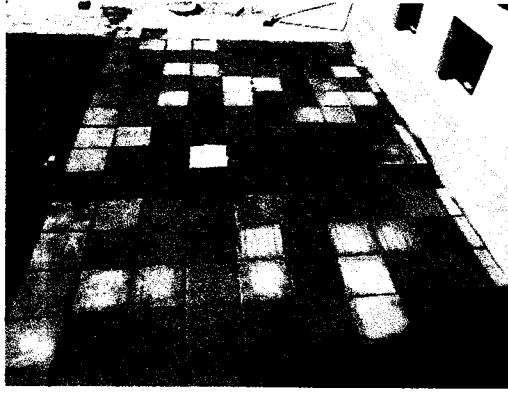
y 34: Colocación de ladrillo pastelero en techo de la zona de subestación. ZONA DE SUBESTACION
